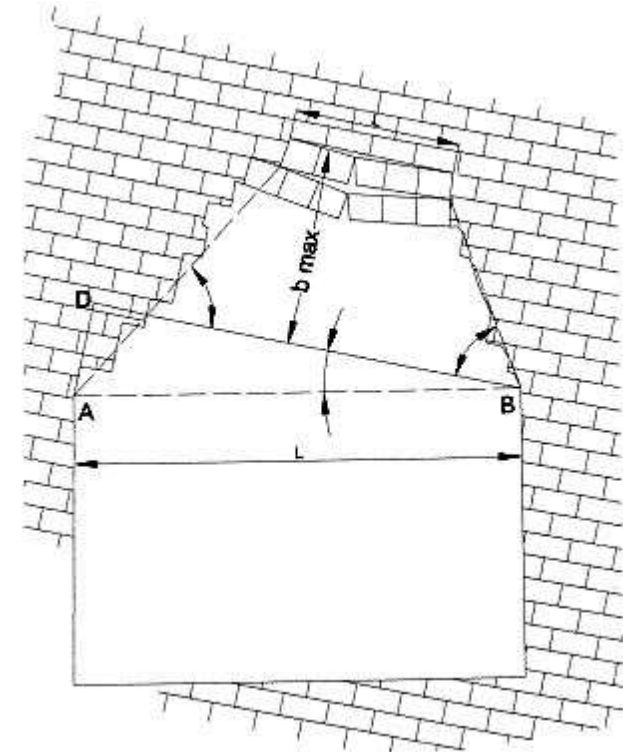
Схема разрушения трещиноватых пород в кровле выработки.
